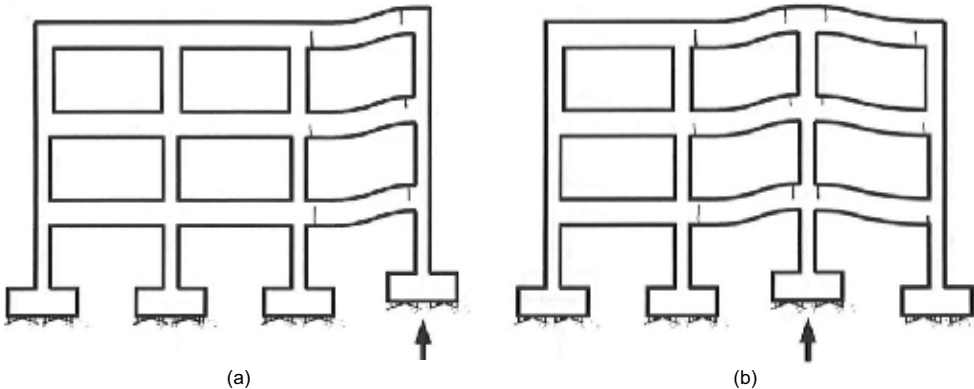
Fisuración por ascenso de pilar. (a) De fachada. (b) Intermedio. (Fuente: Calavera, 2005)
